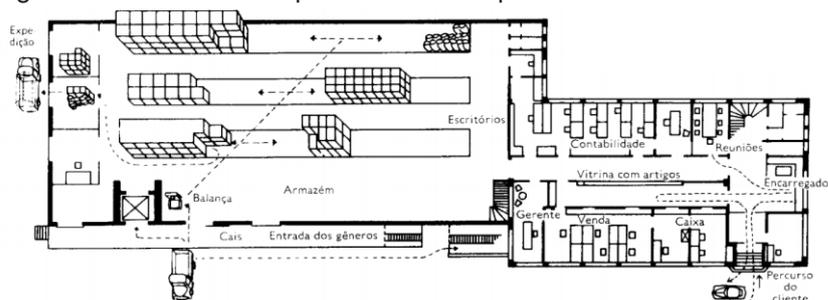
Planta baixa representando o setor de depósito de um mercado.
